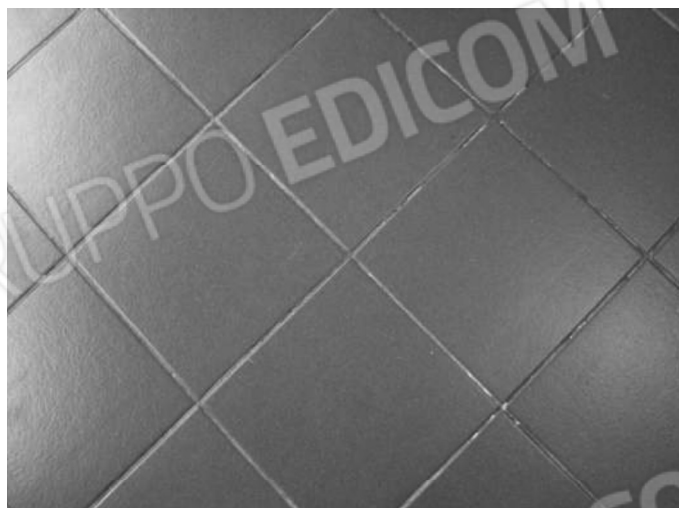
Particolare pavimentazione esterna del Patio 2.
